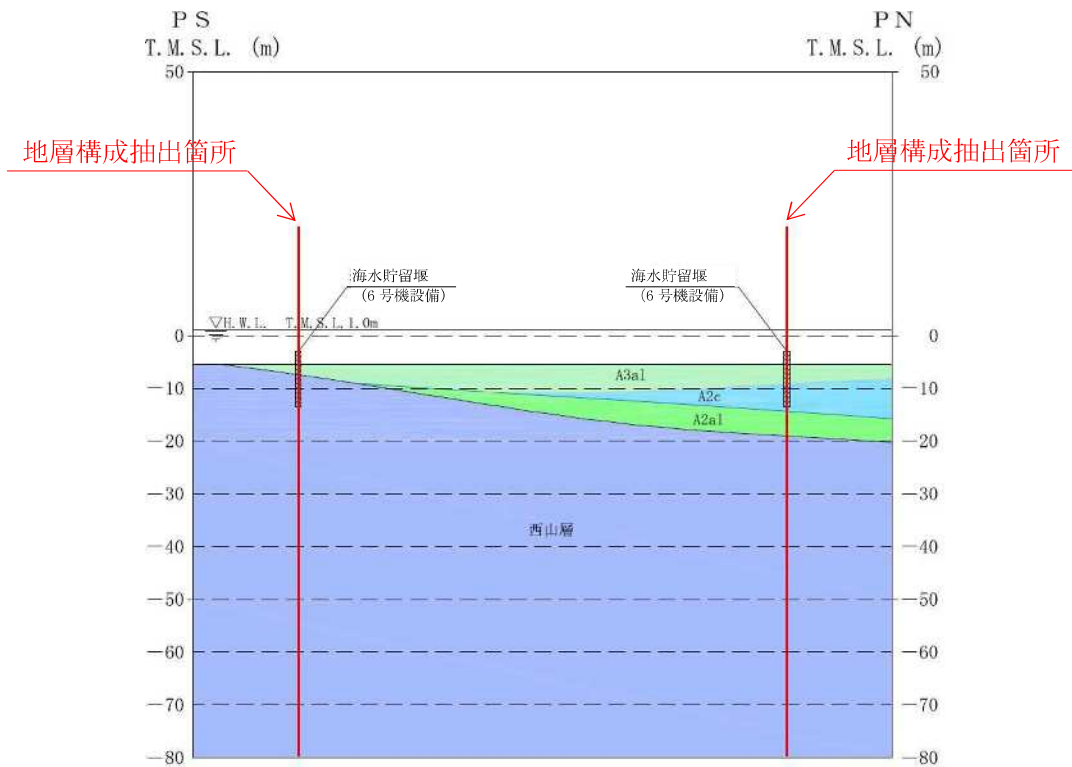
(1) 地質断面图 (A-A断面图)
